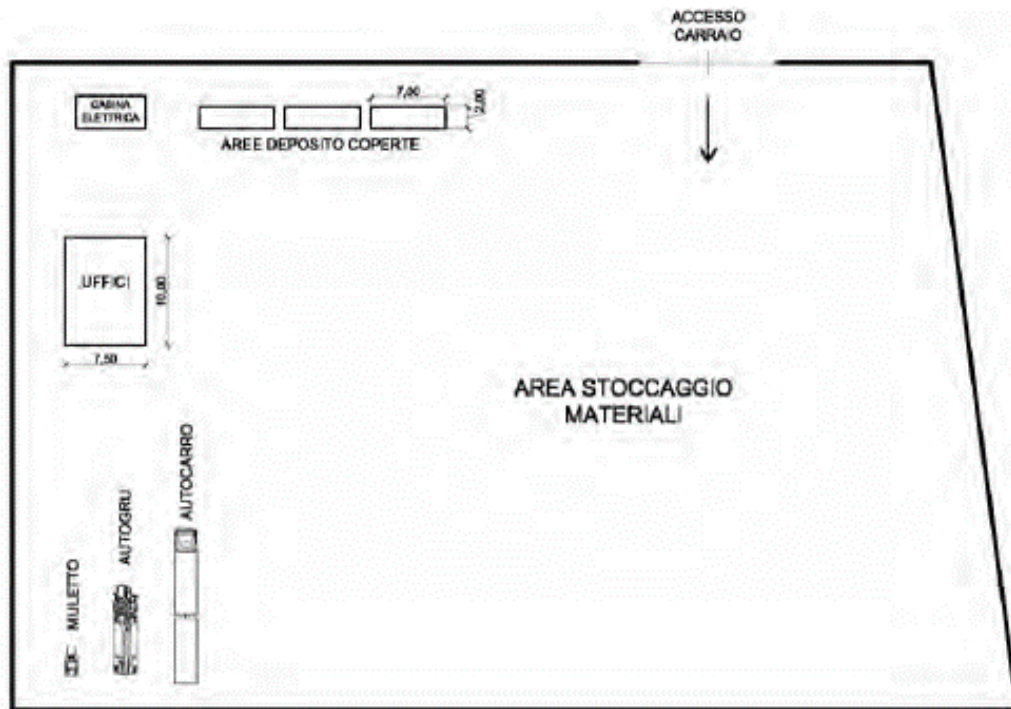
Figura 3 21 – Planimetria dell'Area centrale – Tipologico
